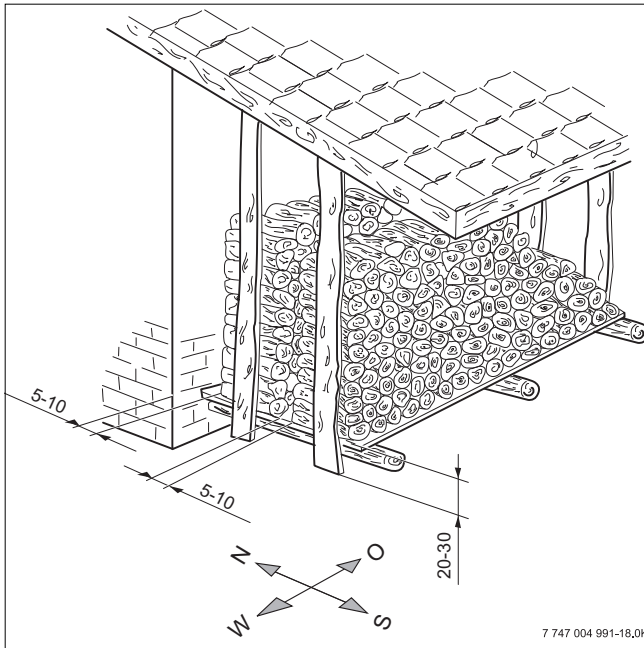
Brennstofflagerung außerhalb von Gebäuden
